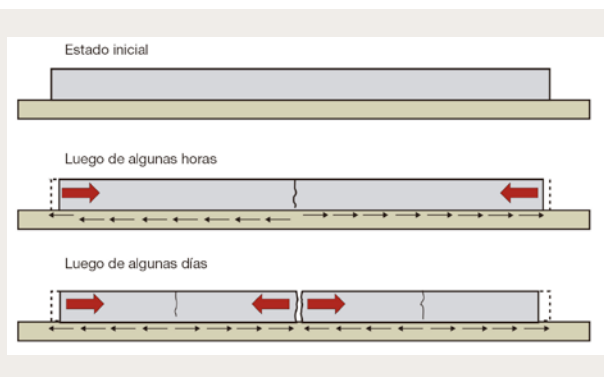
Efecto de la contracción restringida por la subbase o base sobre el patrón de fisuración de las losas de pavimento.
